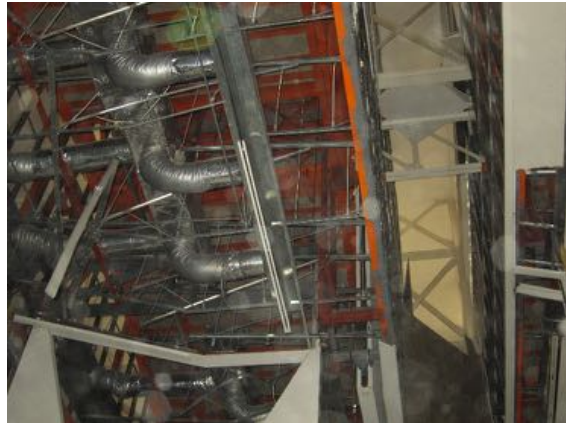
天井裏の状況 (天井脱落箇所)
